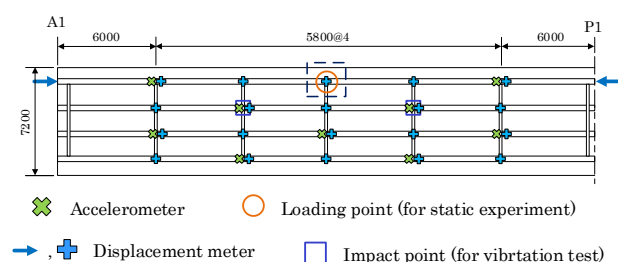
対象橋梁概要とセンサ配置図 (単位: mm)
